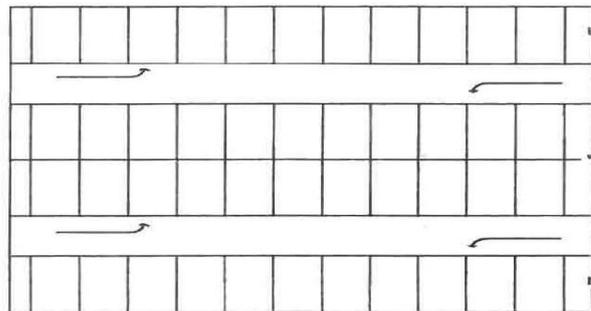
Ilustrasi Parkir sudut yang berhadapan
